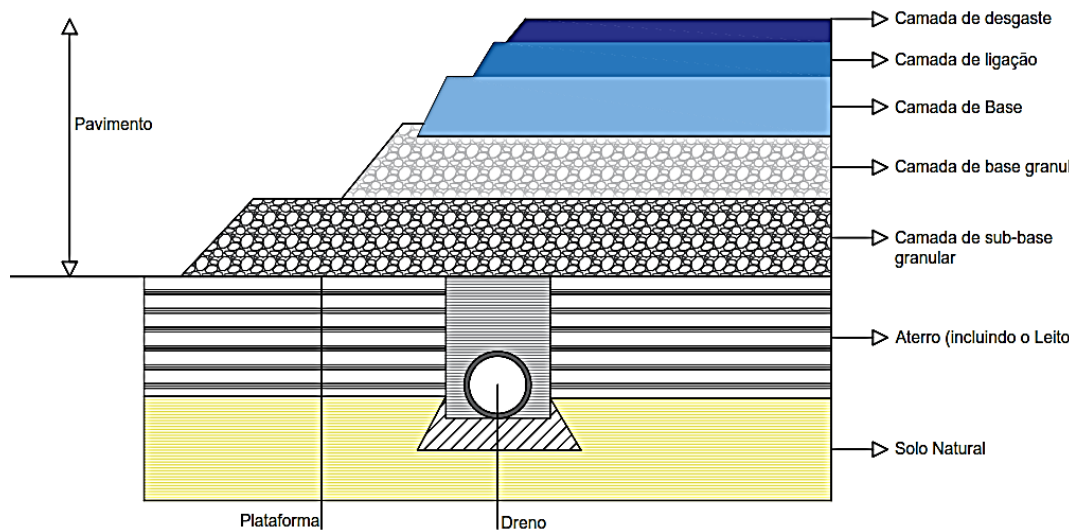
Esquemática da estrutura de um pavimento rodoviário
